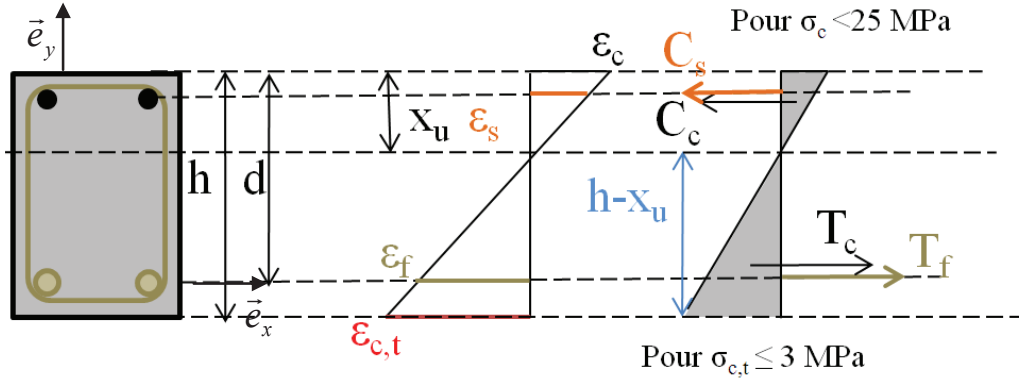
Forces s'exerçant sur la section centrale d'une poutre en phase 1
